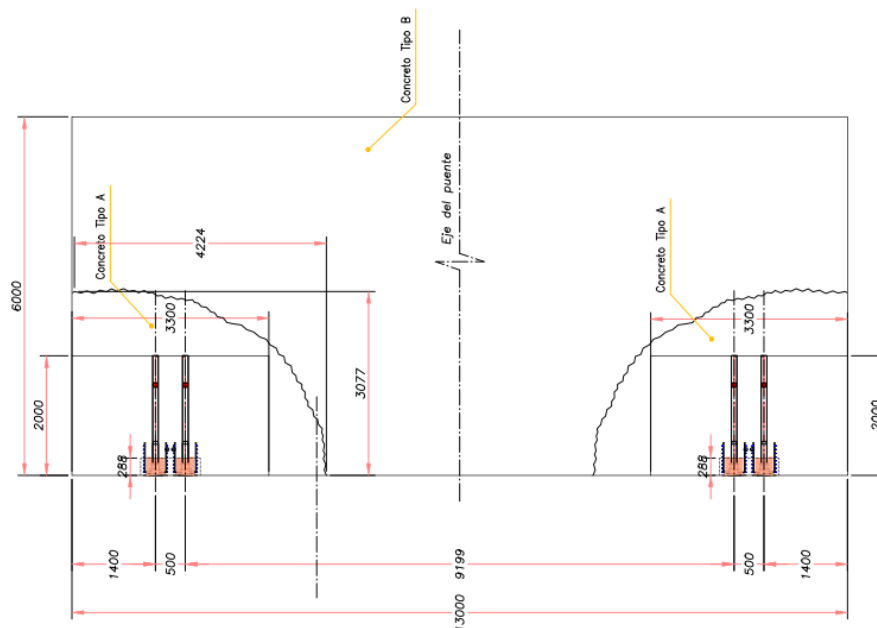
Vista en planta de cámara de anclaje de retenida de Torre Pescante
